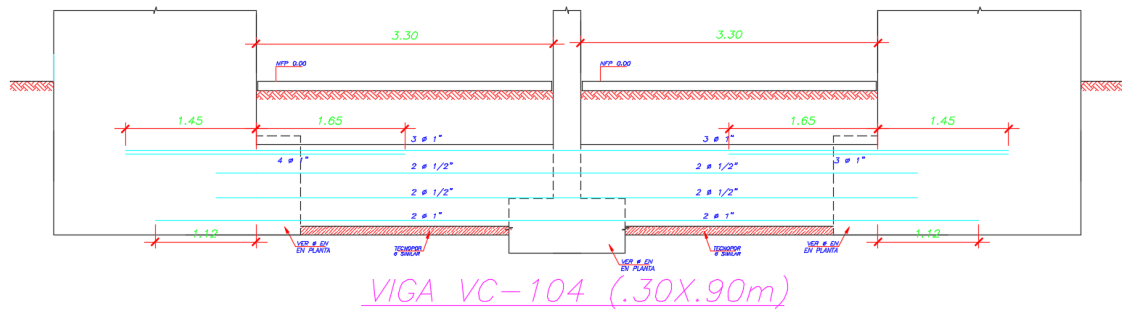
acero de refuerzo para la viga de cimentación VC-104 en AutoCAD.
